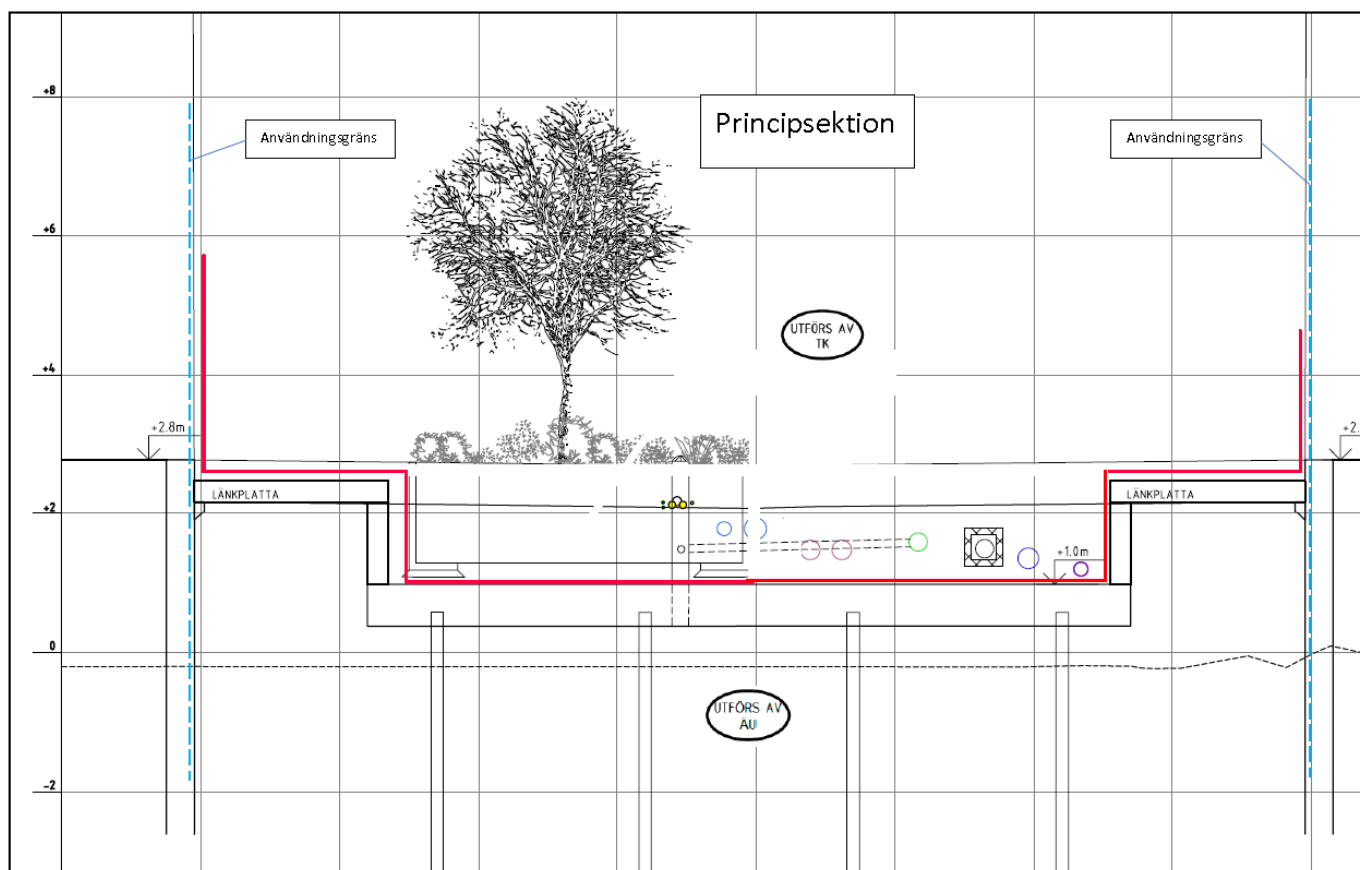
Principiellt gränssnitt för den allmänna platsens indelning i över- och underbyggnad på halvön.
